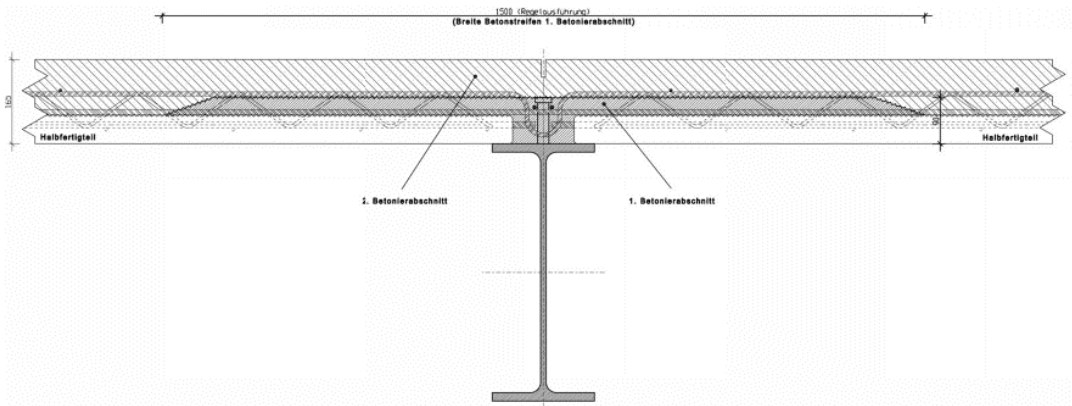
Verbundträger mit schrittweiser Betonage
